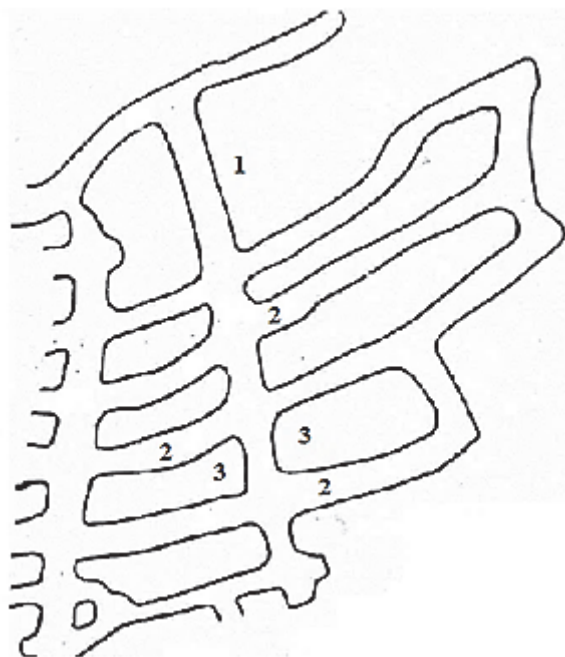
План экспериментального блока с отбойкой из подэтажных штреков:
